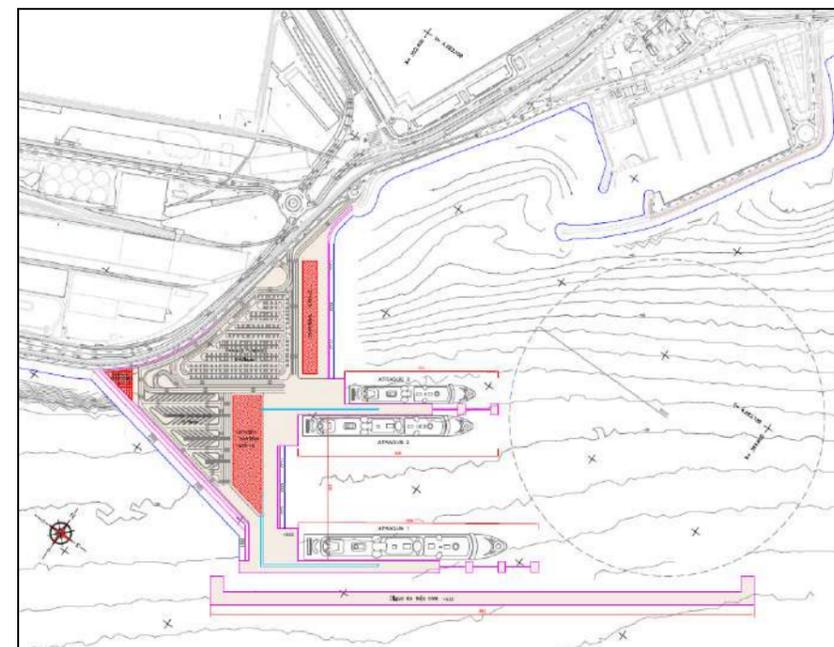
Planta general de la Dársena Exterior de Cruceros (Configuración 2)
